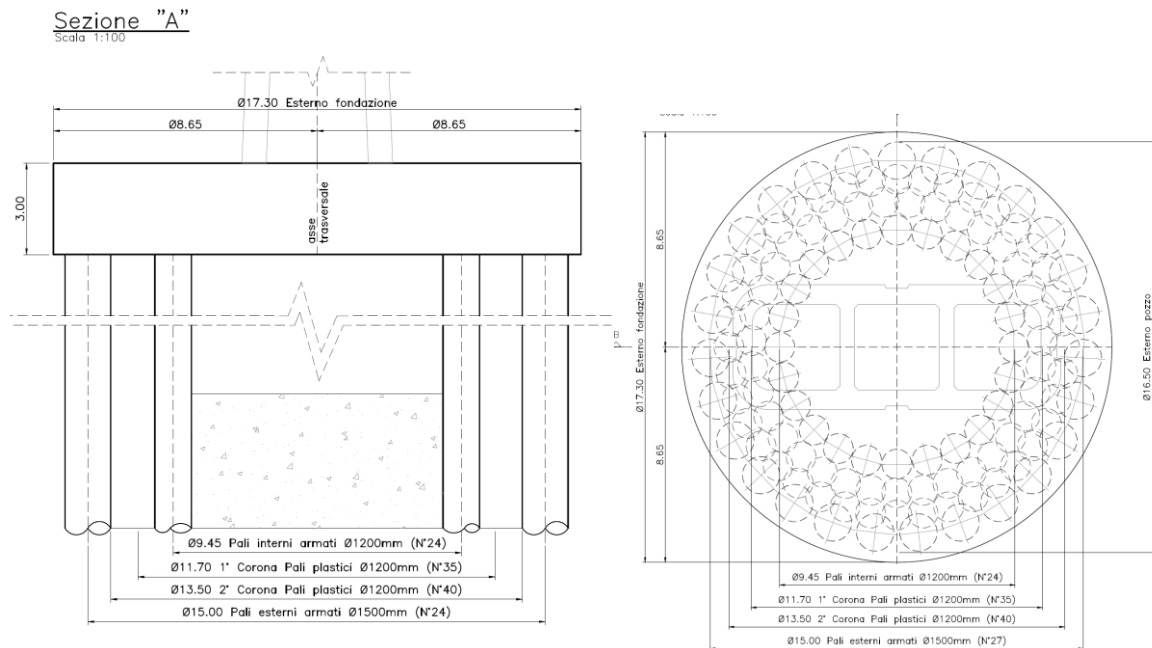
stralcio carpenteria fondazione con pozzo di fondazione circolare di diametro 17.3 m
